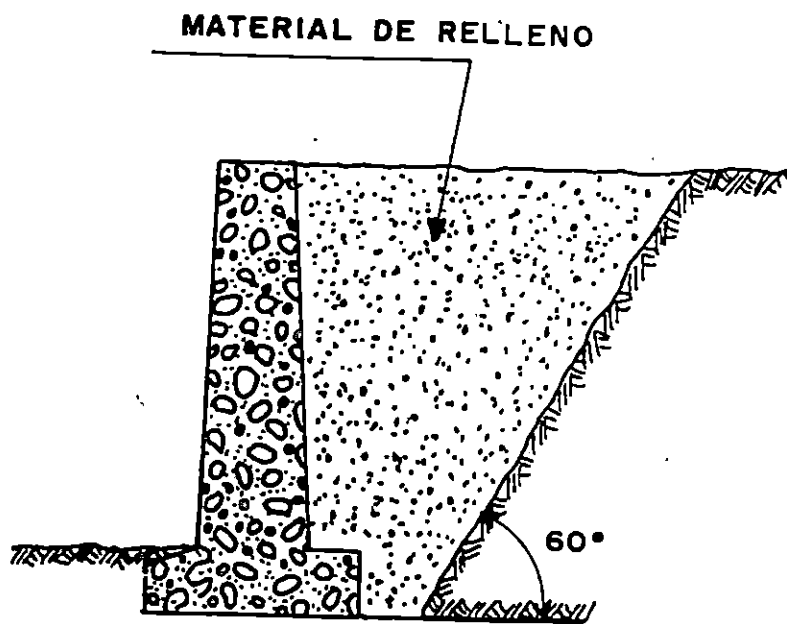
DETALLES DE RELLENO DE UN MURO DE GRAVEDAD.
